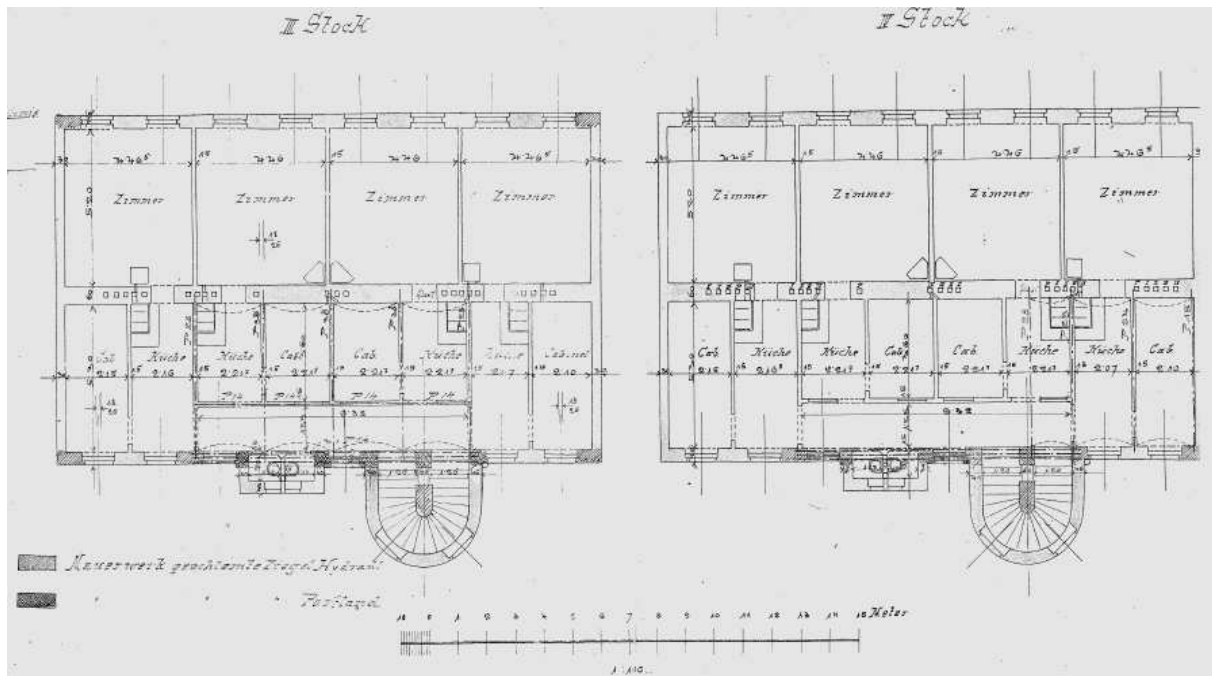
Grundrisse 3. und 4. Stock
